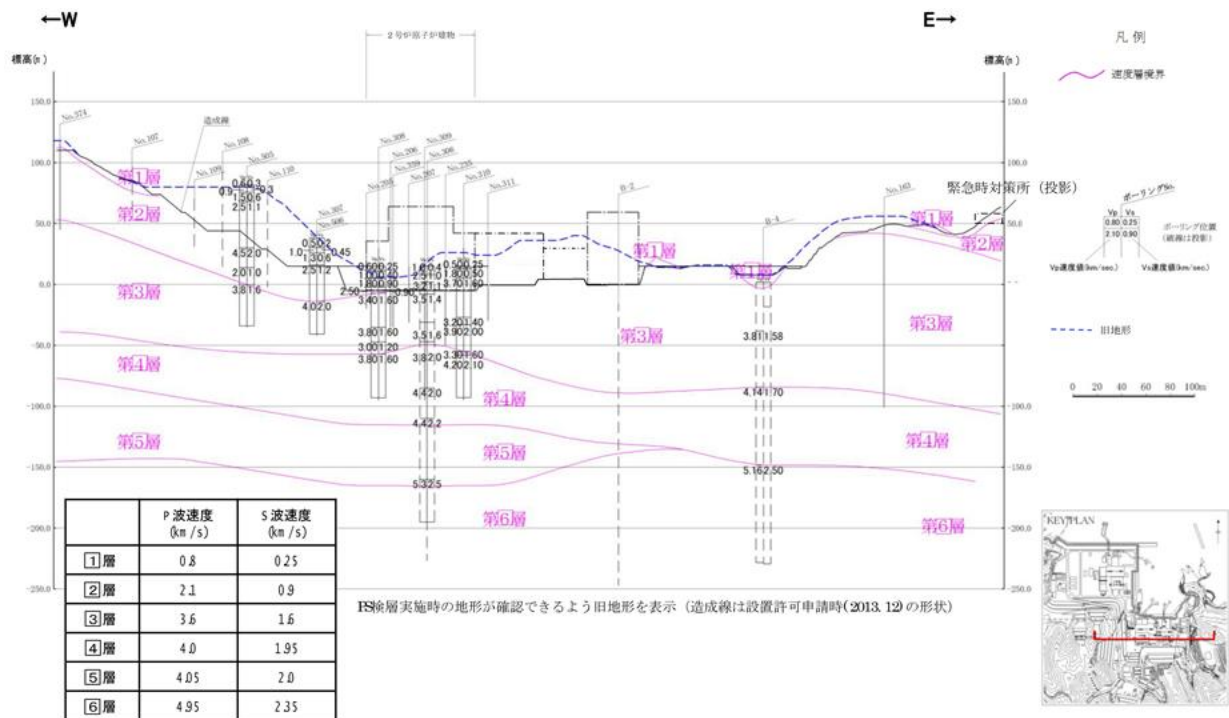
原子炉建物基礎地盤の速度層断面図（東西断面）
